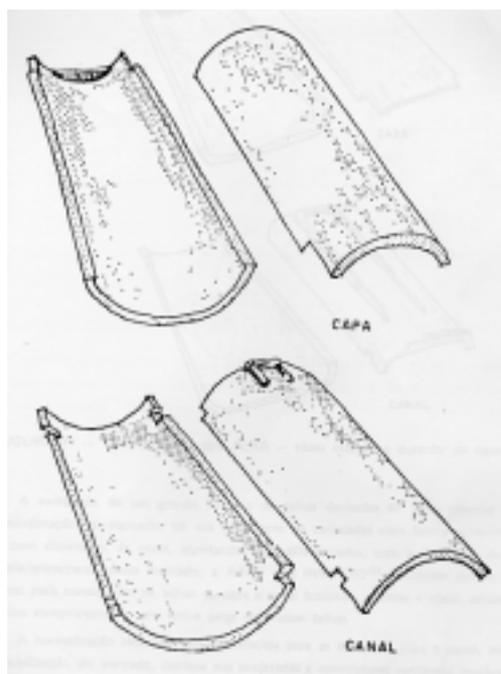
Telha cerâmica capa e canal Paulista (NBR 9598, 1986)
